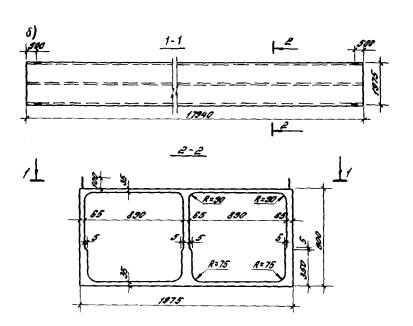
План и разрез двухпустотного настила а - с консольными свесами верхней полки; б - без консольных свесов
